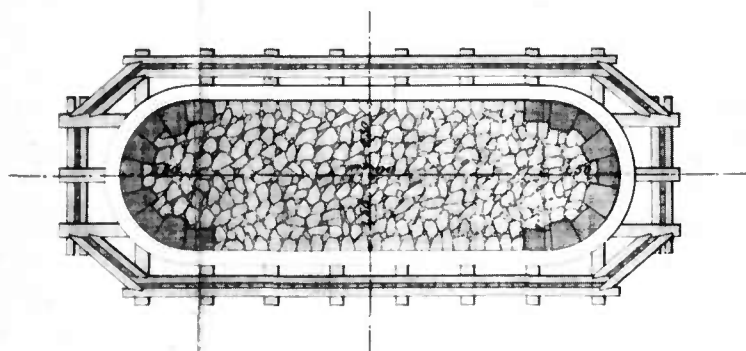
Fondation sur pieux avec blocage par un massif de béton de chaux. Pont de Mauves (fin du XIX<sup>e</sup> siècle).
